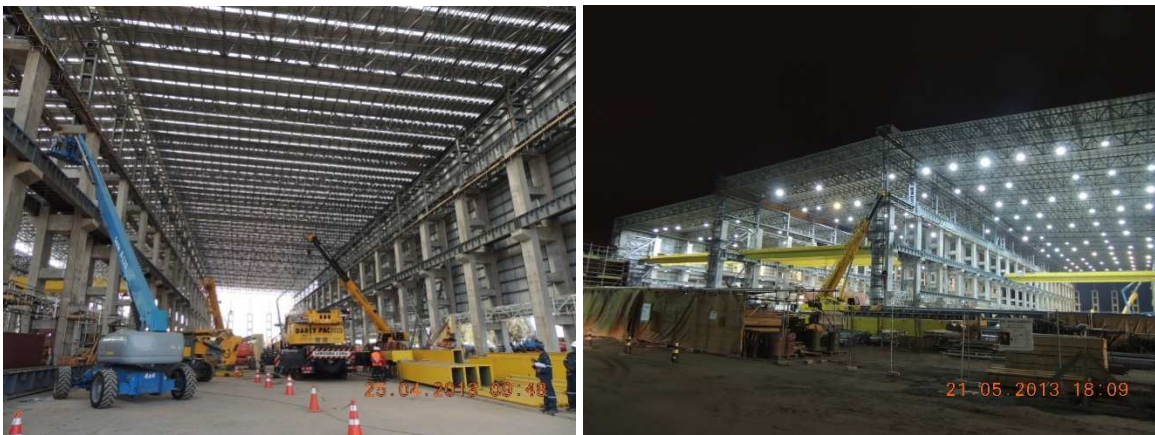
Finalização da montagem da estrutura metálica de cobertura
